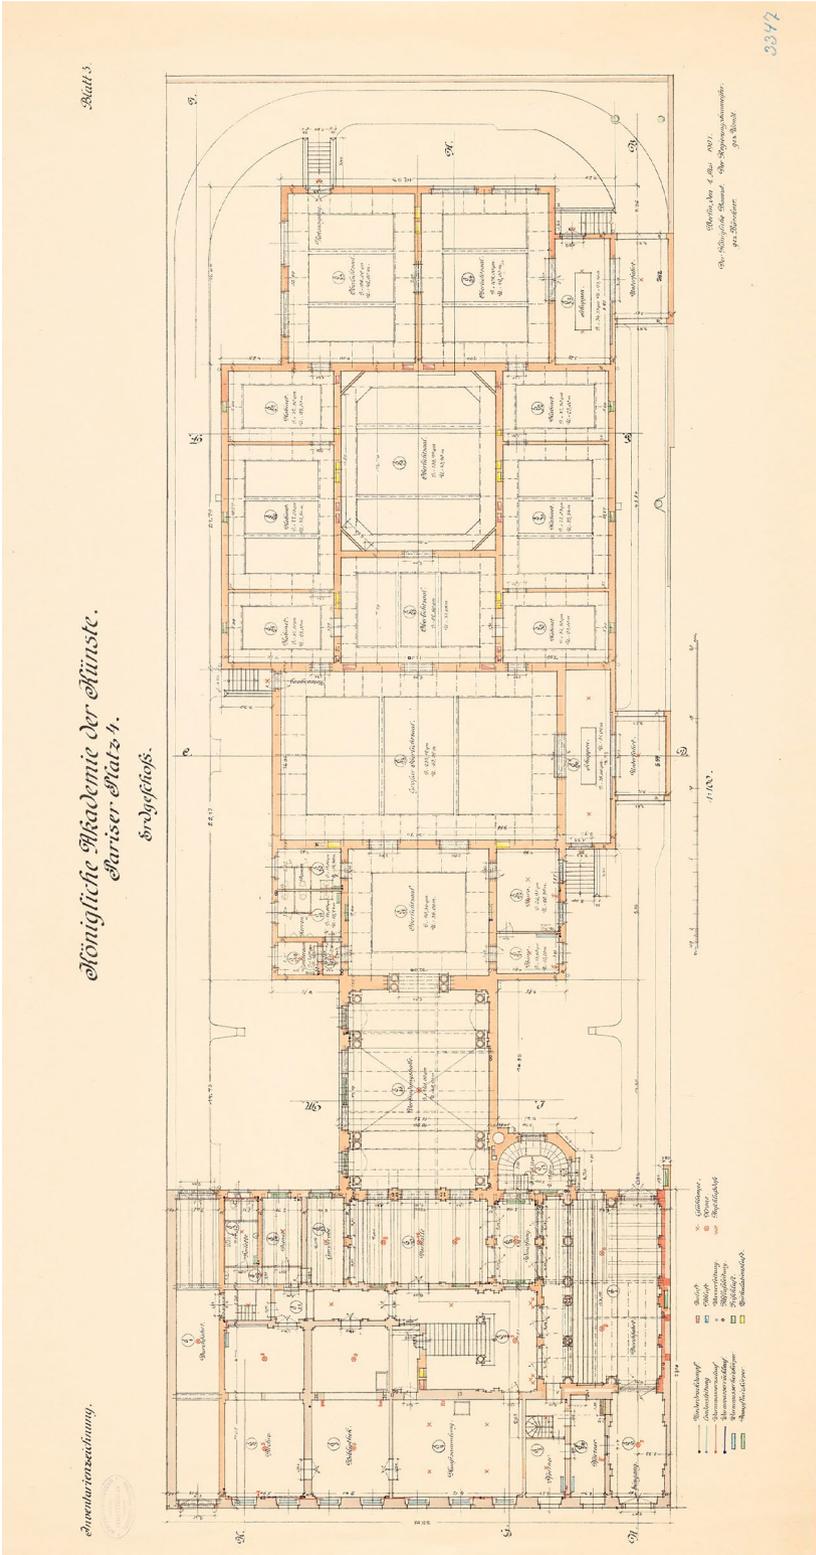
Ernst von Ihne, Akademie der Künste, Berlin. Umbau und Neubau 1904–1907, Grundriss 1. Obergeschoss 1:100, Lithographie farbig auf Karton.
